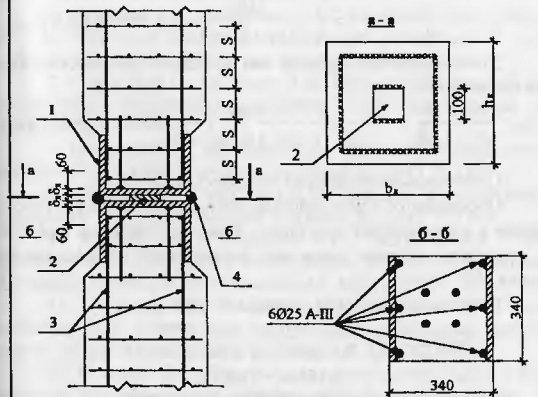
Сварной стык с торцовыми листами
